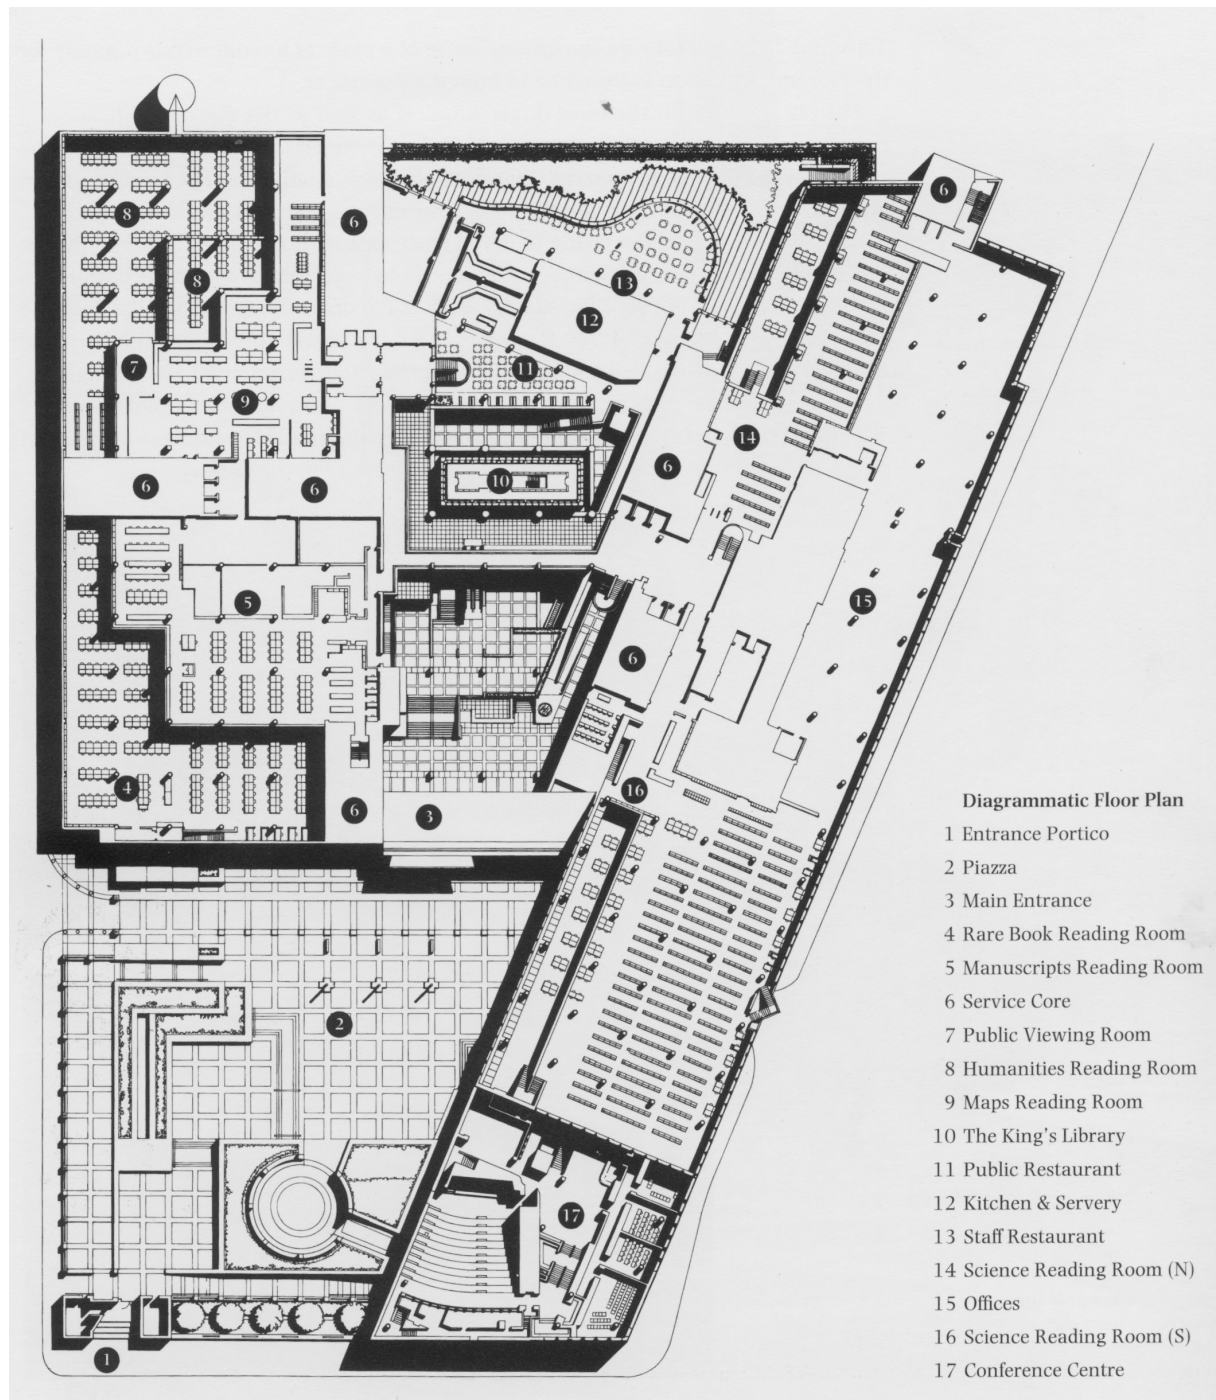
Gebäudeplan. Quelle: Wilson [1998] S. 42
